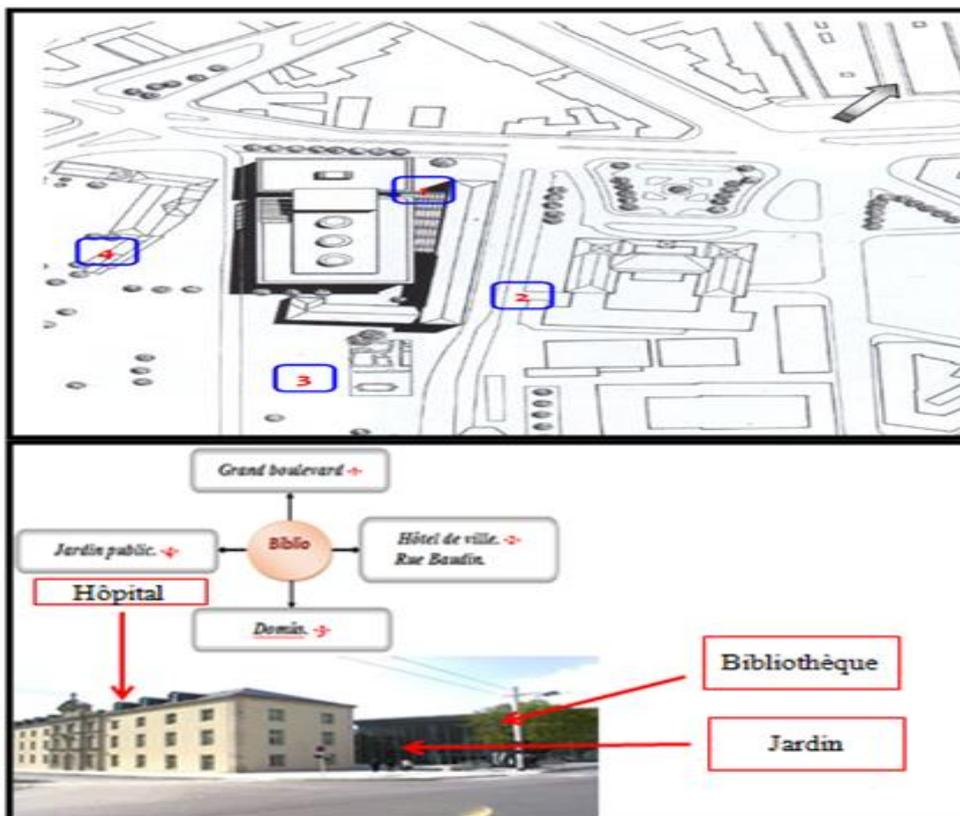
Plan De Masse du projet (source : <https://www.archdaily.com> )
